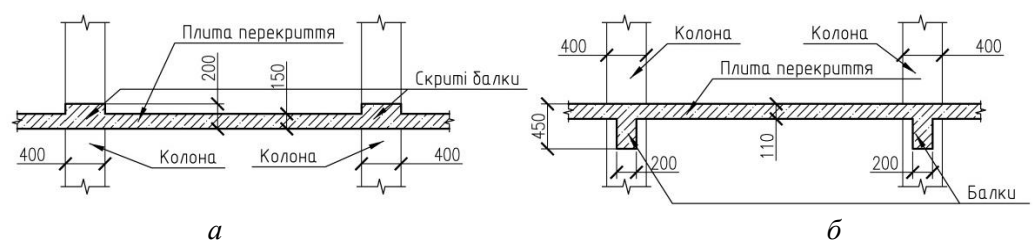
Варіанти конструктивного рішення монолітного перекриття житлової будівлі:
